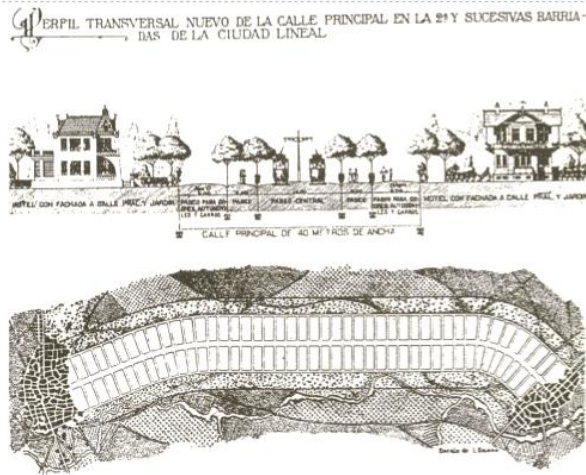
Plano y sección del proyecto para la Ciudad Lineal de Madrid.
